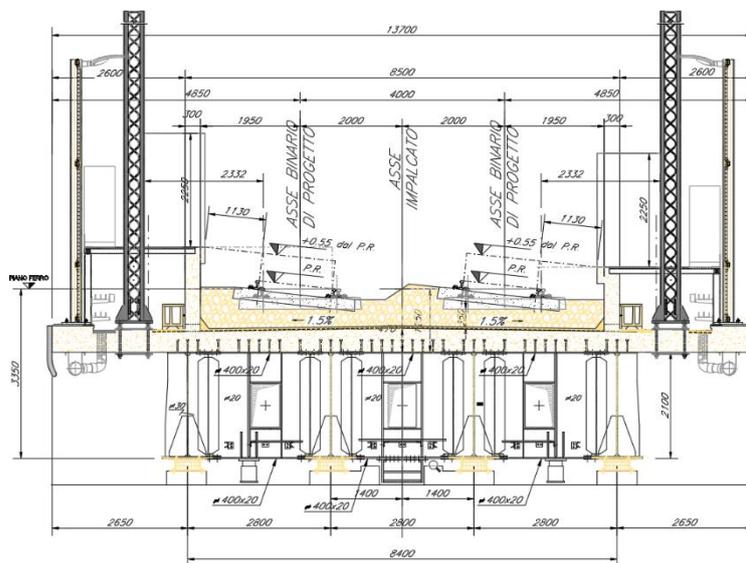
Sezione trasversale tipo (H travi = 2.10 m) – testata
